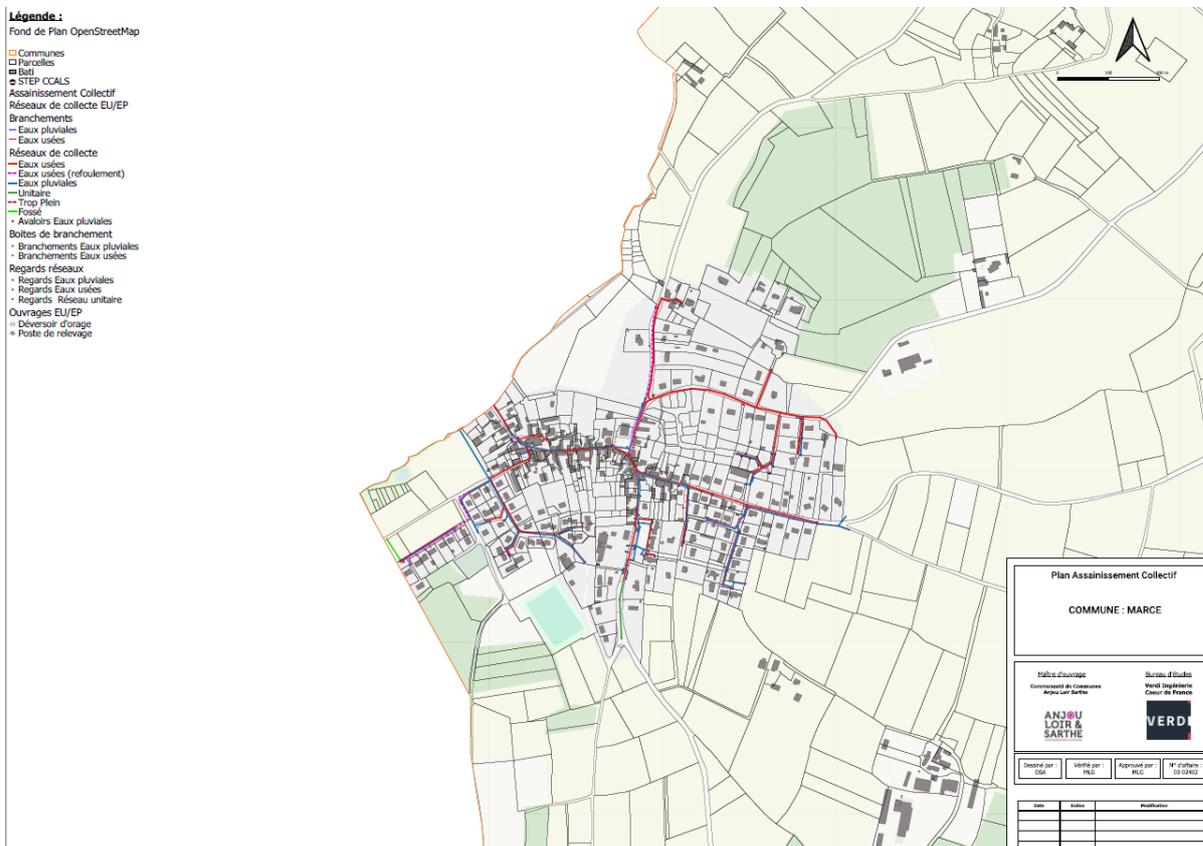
Plan de fonctionnement du réseau d'assainissement du secteur bourg
